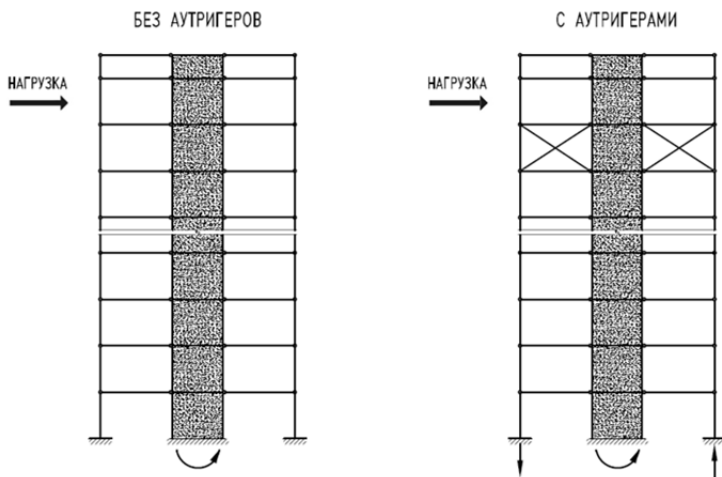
Схема восприятия горизонтальных нагрузок несущим каркасом высотного здания
